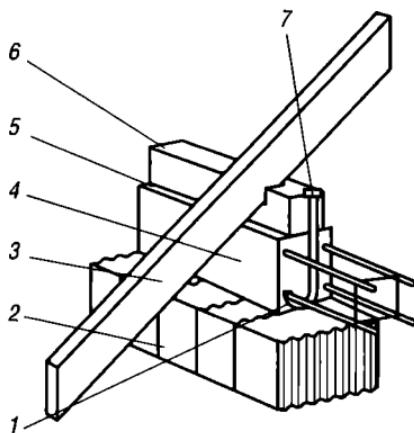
Соединение мауэрлата с железобетонным венцом стены:
